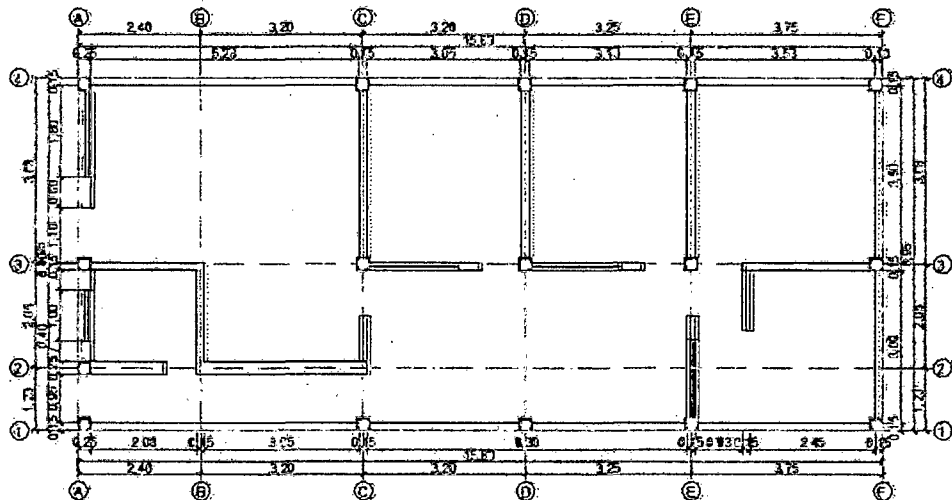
Plano de arquitectura de la planta típica de la Vivienda TV4.
